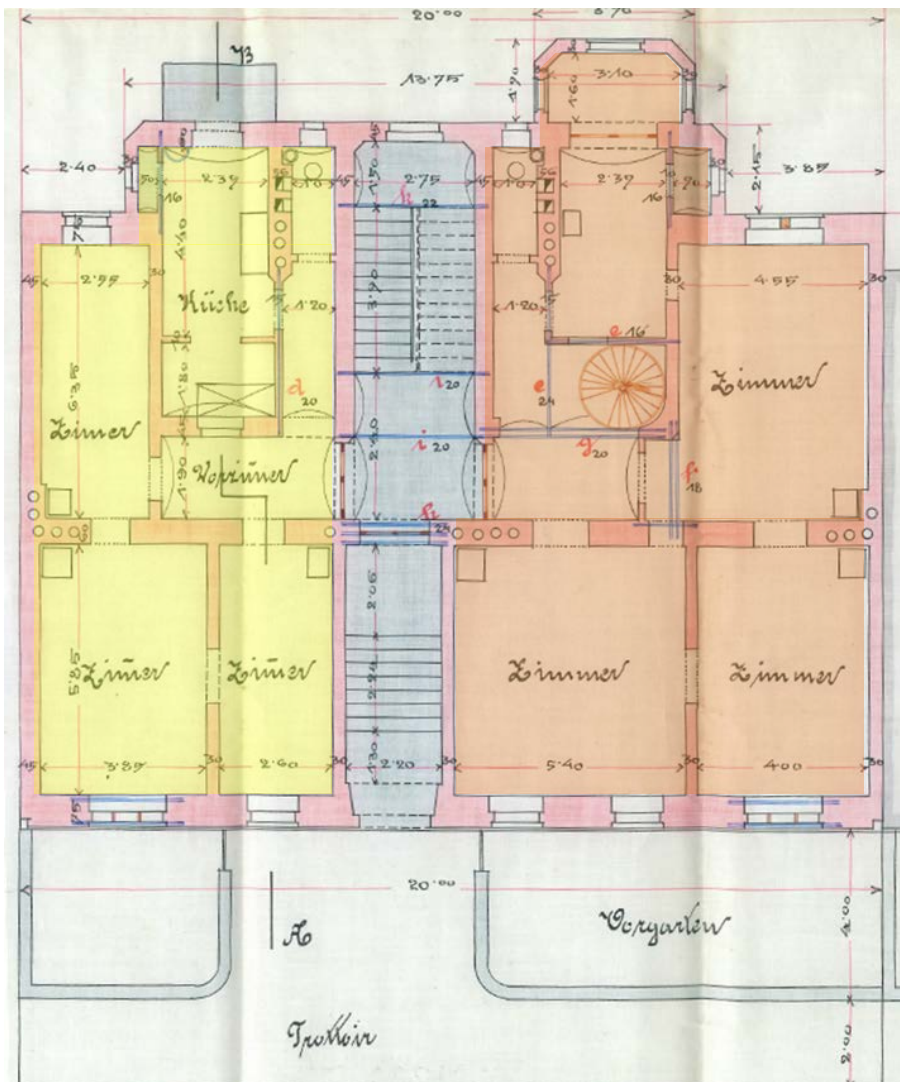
Grundriss Gründerzeitpalais Erdgeschoß<sup>85</sup>
